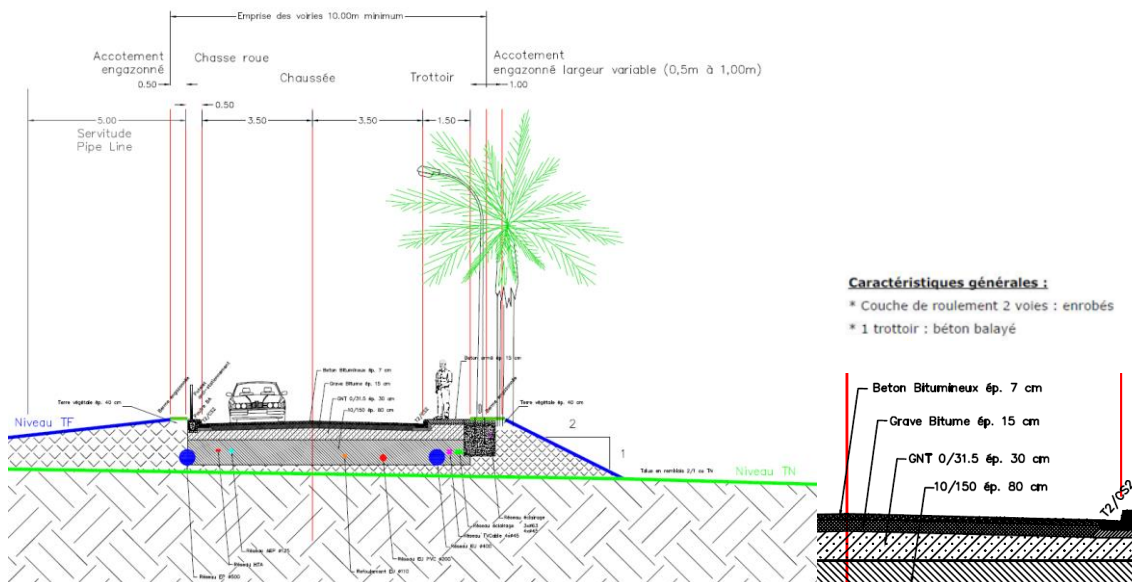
Profils en travers type de la voie de liaison (source : Suez Consulting)
